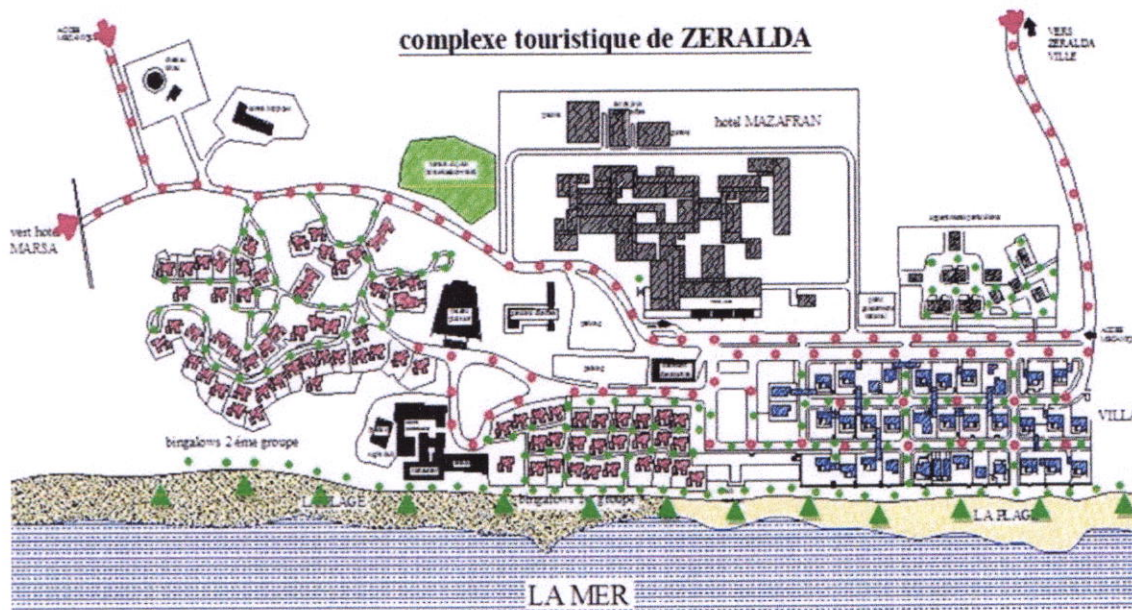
Plan d'accessibilité du complexe (source mémoire village touristique balnéaire au andalouse 2014)
